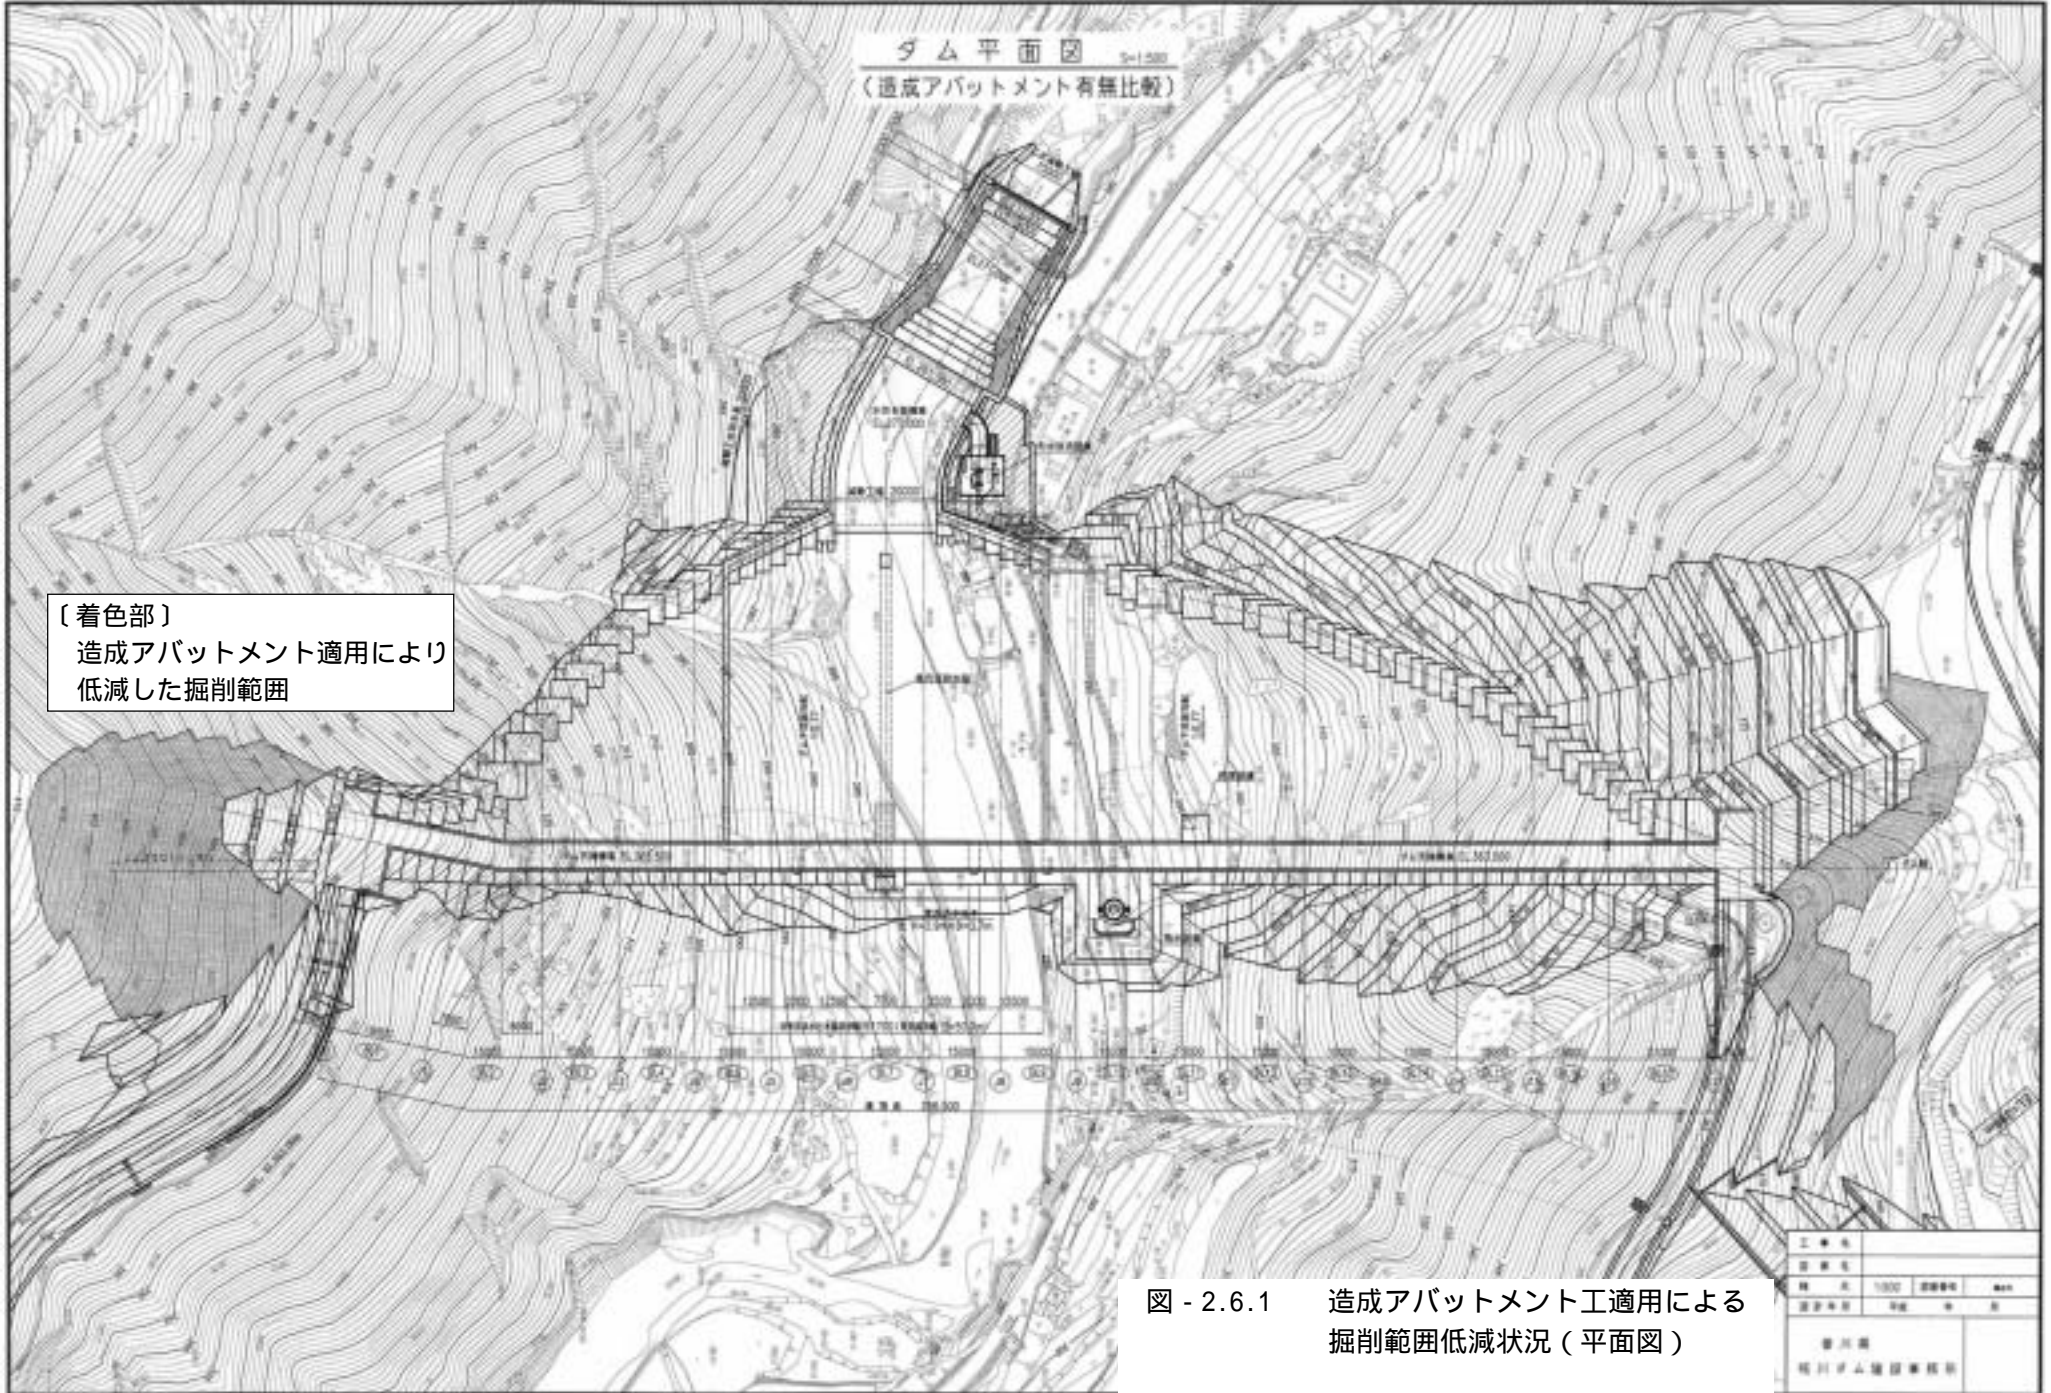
造成アバットメント工適用による掘削範囲低減状況 (平面図)
